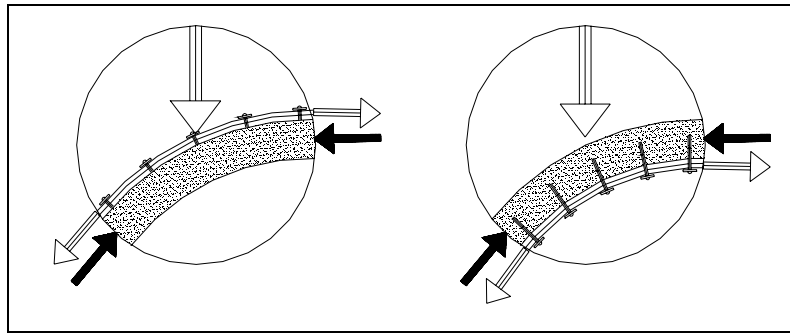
Dettaglio dell'interfaccia tra tirante e muratura. (a sinistra) cavo estradossale con connettori in compressione (a destra) cavo intradossale con connettori in trazione
